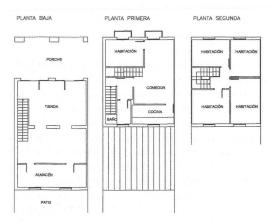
Distribución de las viviendas de tres plantas del barrio de Sant Cugat (dibujo de Ramón Ripoll)
